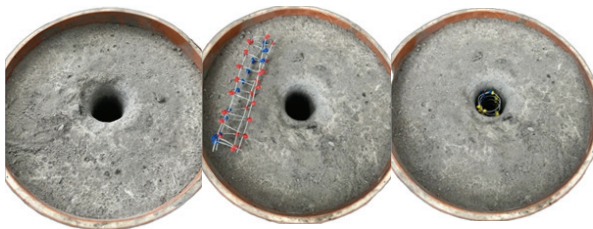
Демонтаж опалубки сваи с последующим монтажом арматуркаса
